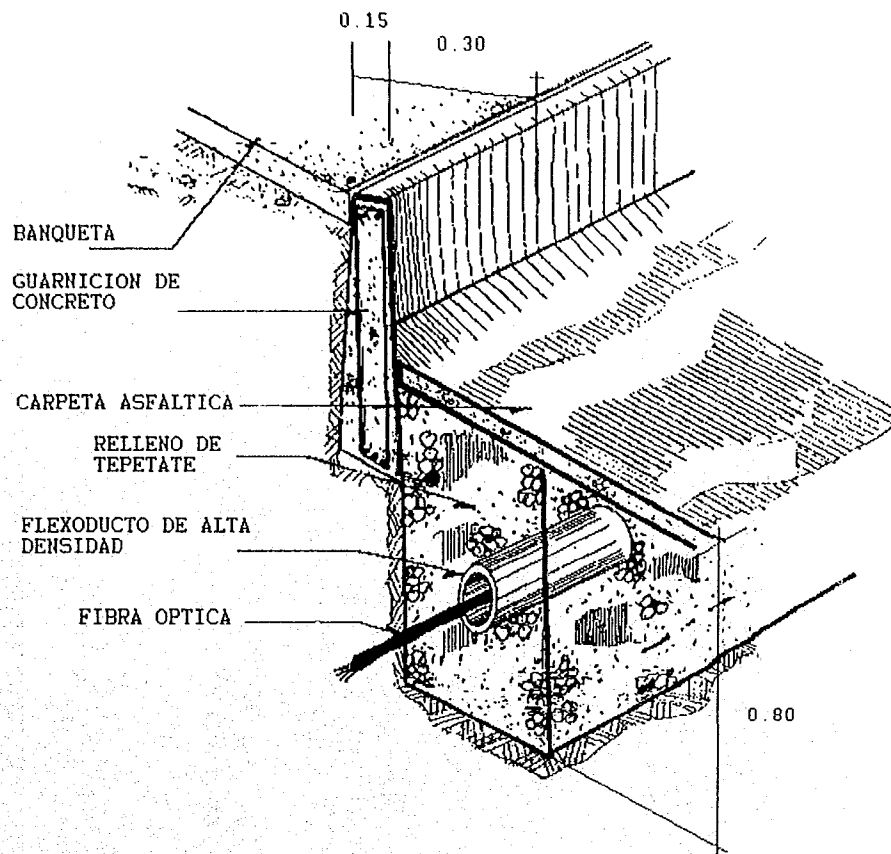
Diagrama de tendido de fibra óptica sobre el pavimento
